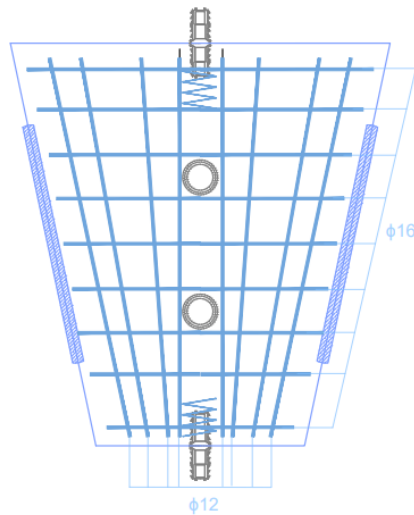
Plano Dovela – Armadura Vista Inferior
